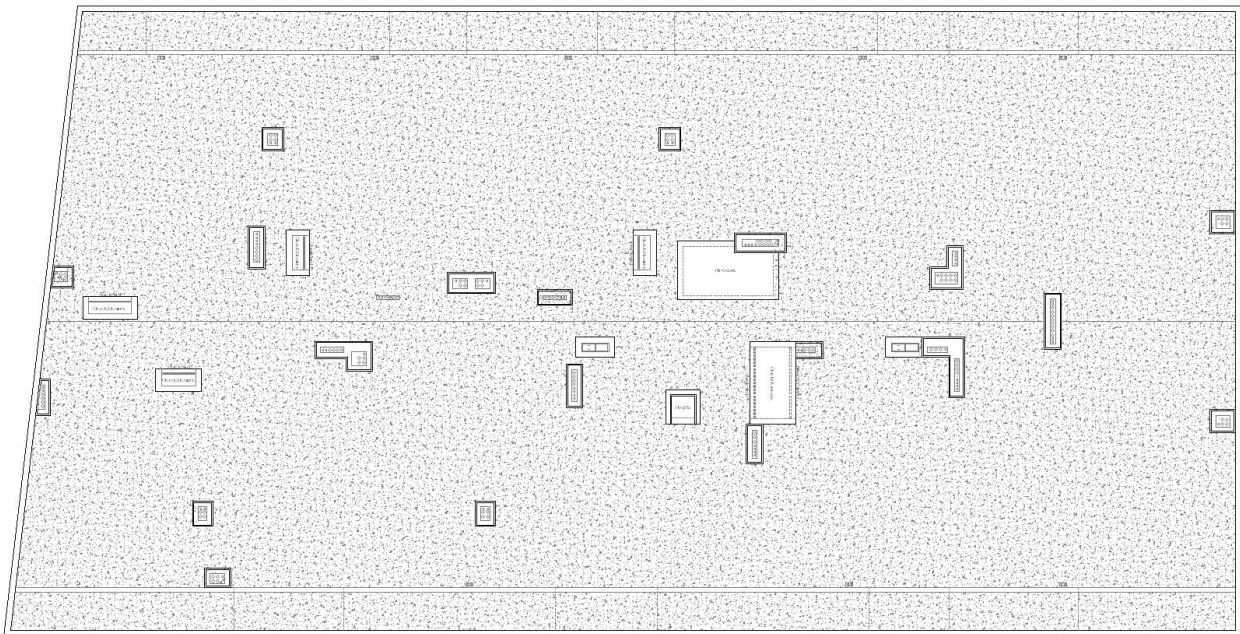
Planta arquitetônica da cobertura (Projeto de Arquitetura)
